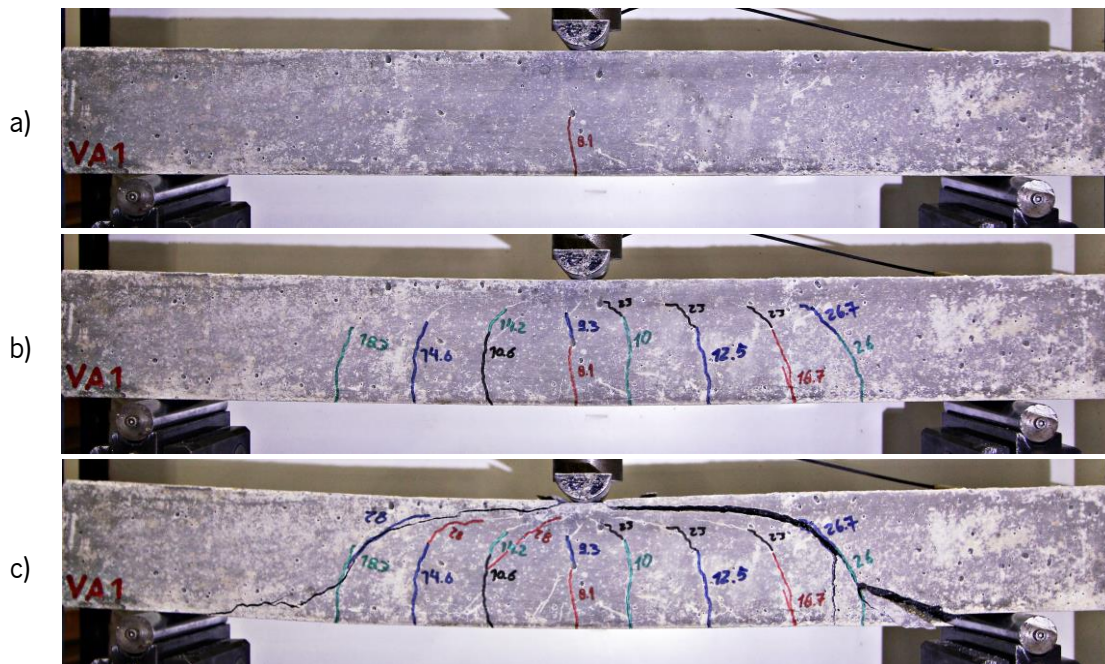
Padrão fissuração laboratorial tipo em vigas de armadura BCR3 (a - primeira fissura; b - pré-esmagamento do betão; c - esmagamento do betão).
